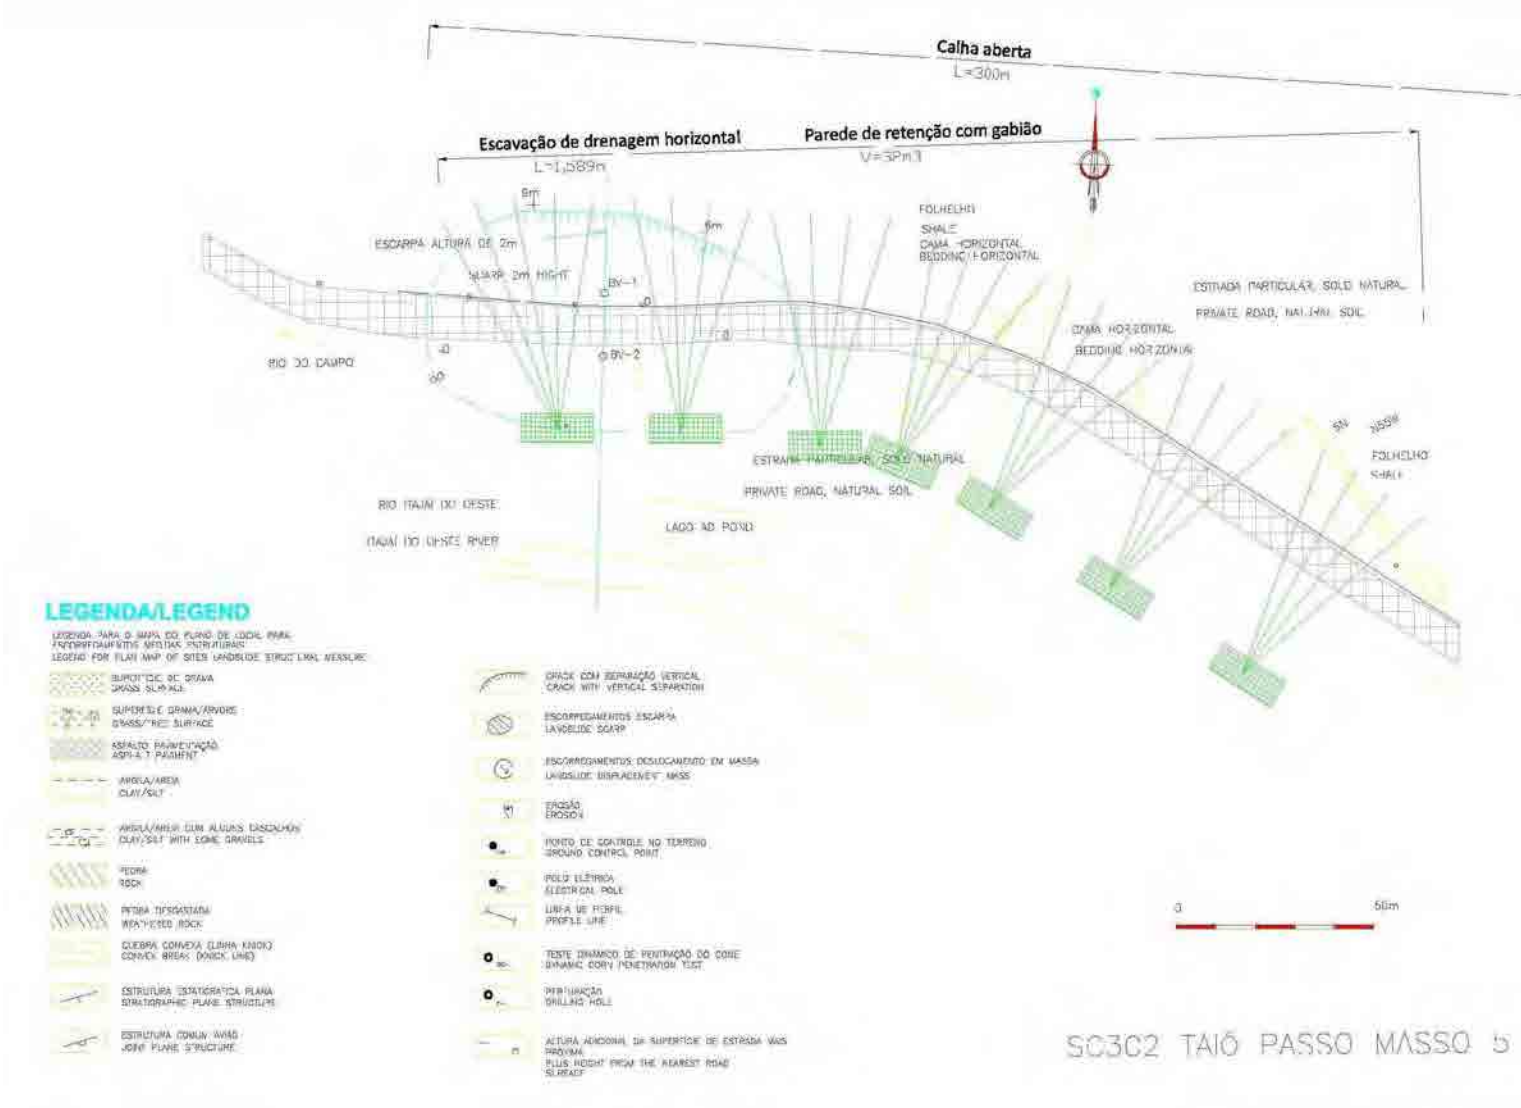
Planta da medida estrutural para a prioridade N° 1 Escorregamento na SC 302 Taió - Passo Manso-5
